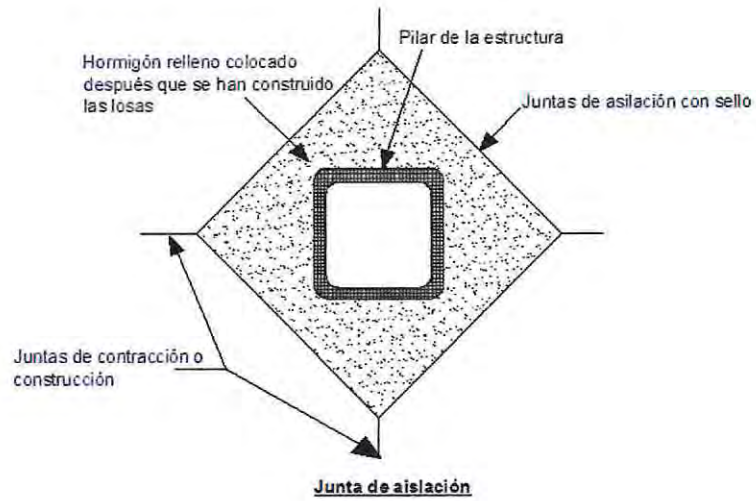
Juntas de aislación en muros y pilares (ACI 360R-10).
